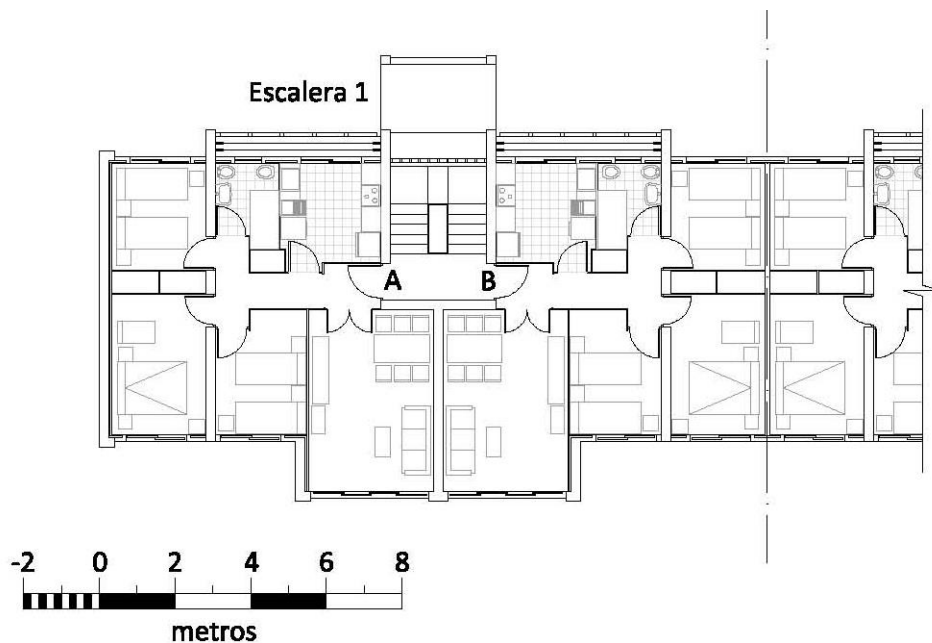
Plano de la planta tipo de la Escalera 1 del Bloque H. Escala 1:200
